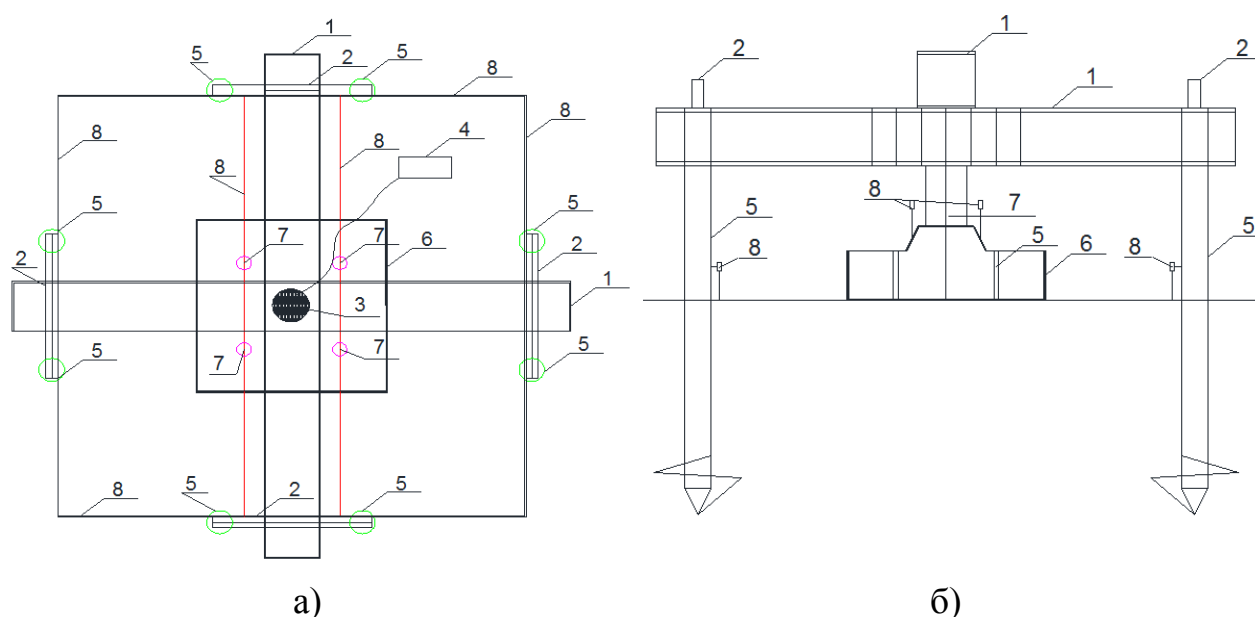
Устройство для испытания грунтов, армированных цементно-песчаным раствором: а – вид сверху; б – вид сбоку
